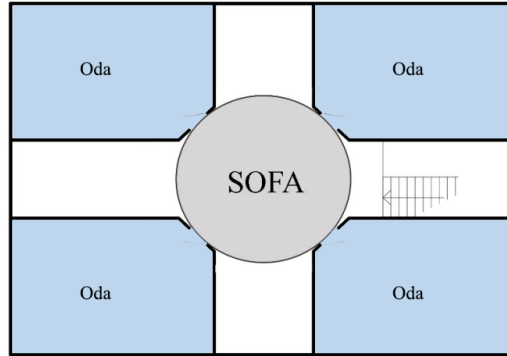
İç sofalı plan tipi (Eldem, 1954).
